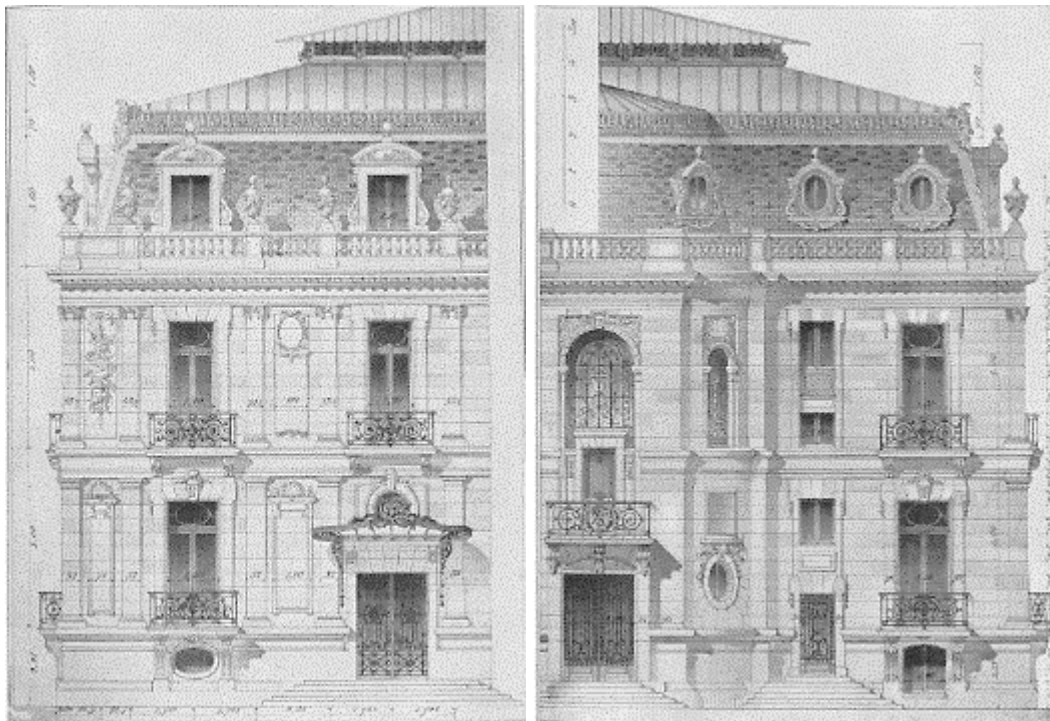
Diseño de Montejo 495. Fachada principal y acceso secundario. Fuente: “La Construction Moderne n° 31”, (Umbdenstoc, 1907)
